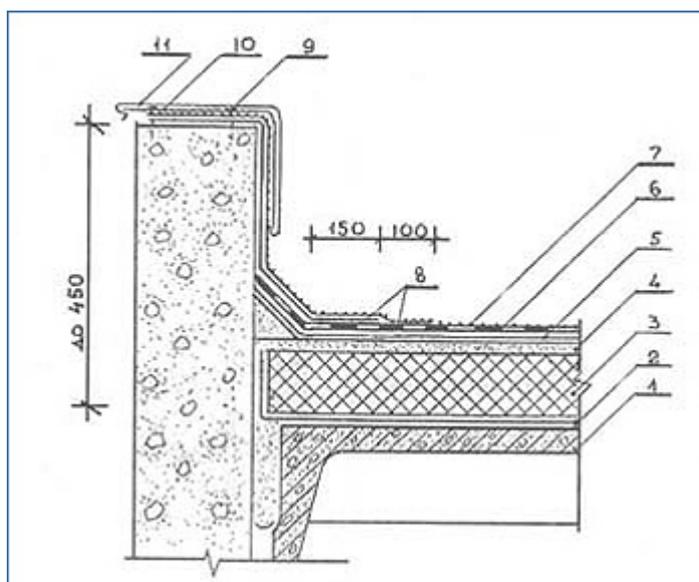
Примыкание кровли к парапету высотой до 450мм: 1 - сборная железобетонная плита покрытия; 2 – пароизоляция; 3 – теплоизоляция; 4 - выравнивающая стяжка; 5 - грунтовка (праймер); 6 - основной кровельный ковёр; 7 - крупнозернистая посыпка верхнего слоя наплавляемого рулонного материала; 8 - дополнительные слои кровельного ковра; 9 - крепёжные элементы; 10- костыли из стальных полос 400х40 мм через 600 мм; 11- покрытие парапета
